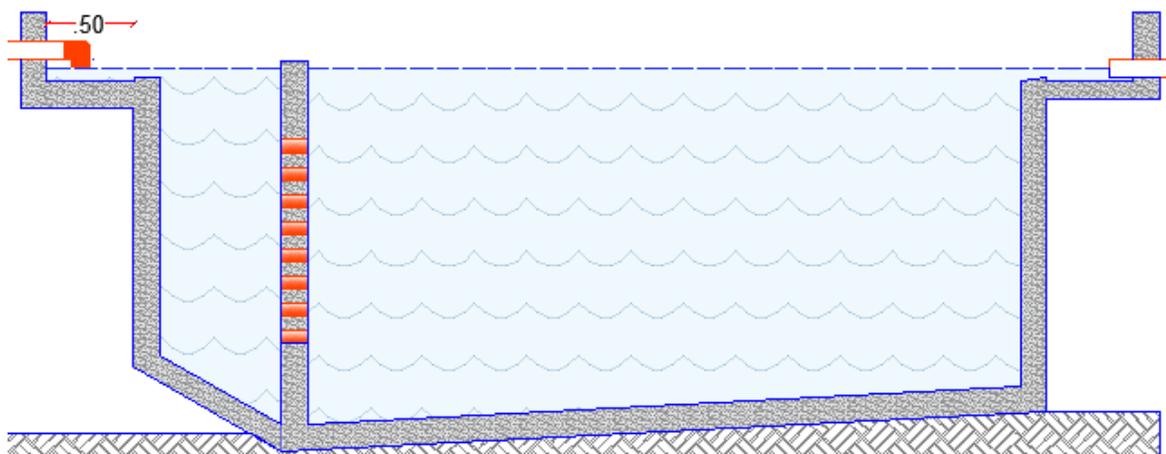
Sedimentador (Perfil Longitudinal).
